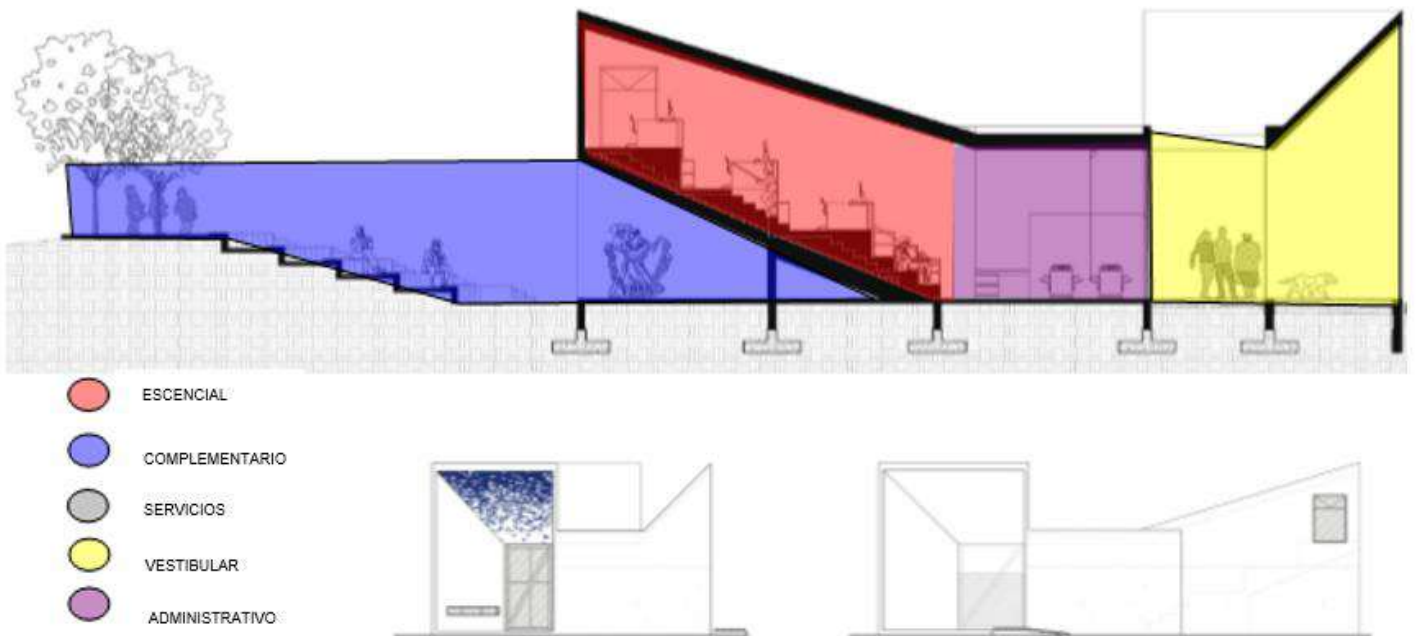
Sección y fachadas arquitectónicas Biblioteca Casa de las Ideas
